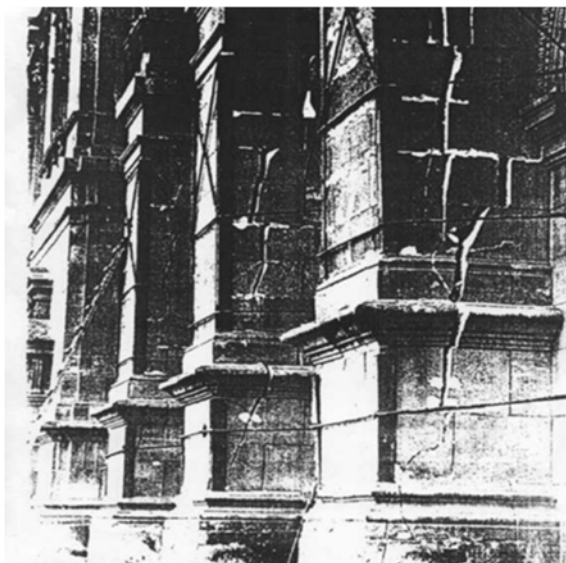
Fisurarea pilaștrilor frontale în urma seismului din 1977
